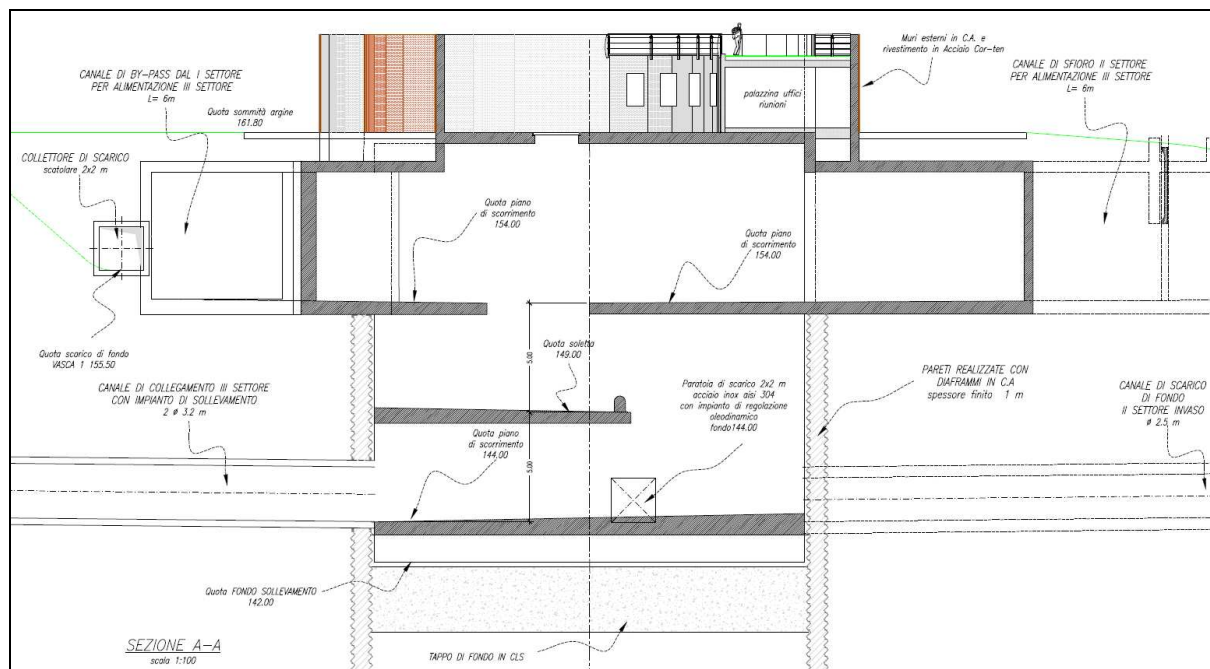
Sezione longitudinale della porzione di pozzo che svolge la funzione di collegamento tra il secondo (o primo) e il terzo settore dell'invaso
